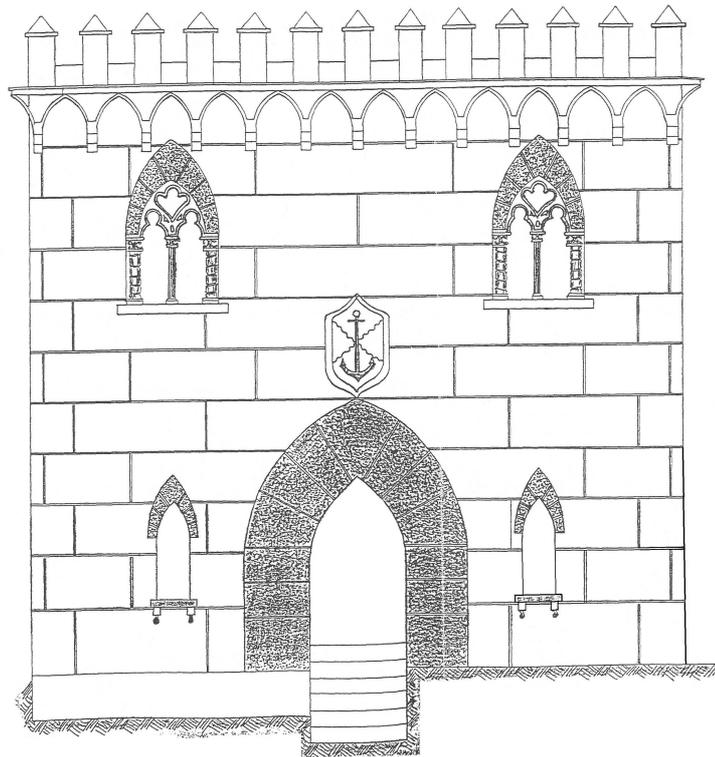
Fachada principal de Santa Catalina. (Plano de la AMM)
